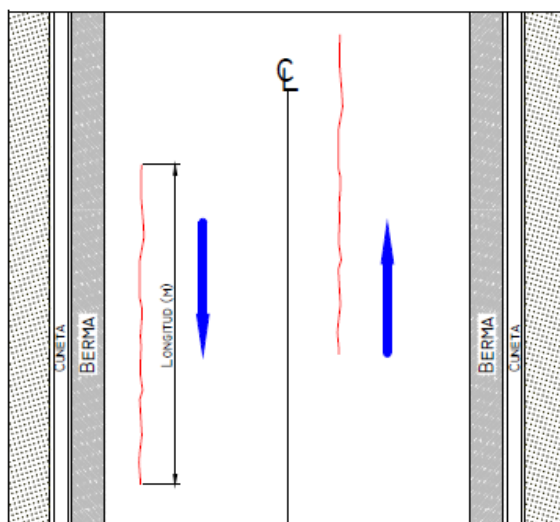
Fisura longitudinal sobre pavimento asfáltico existente
